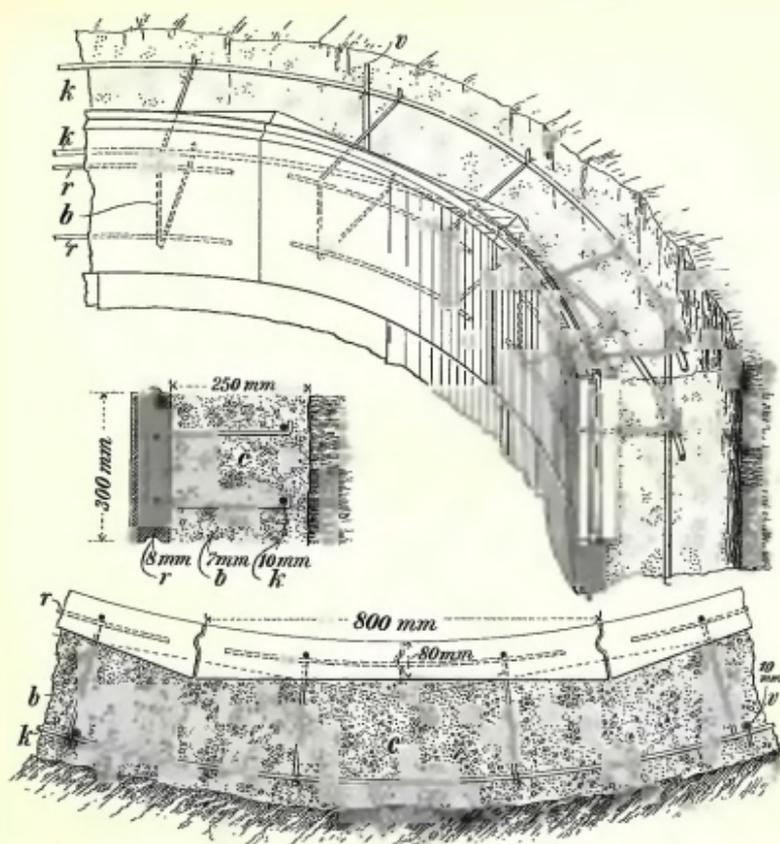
Schachtausbau mit Eisenbeton unter Verwendung von Formsteinen.
